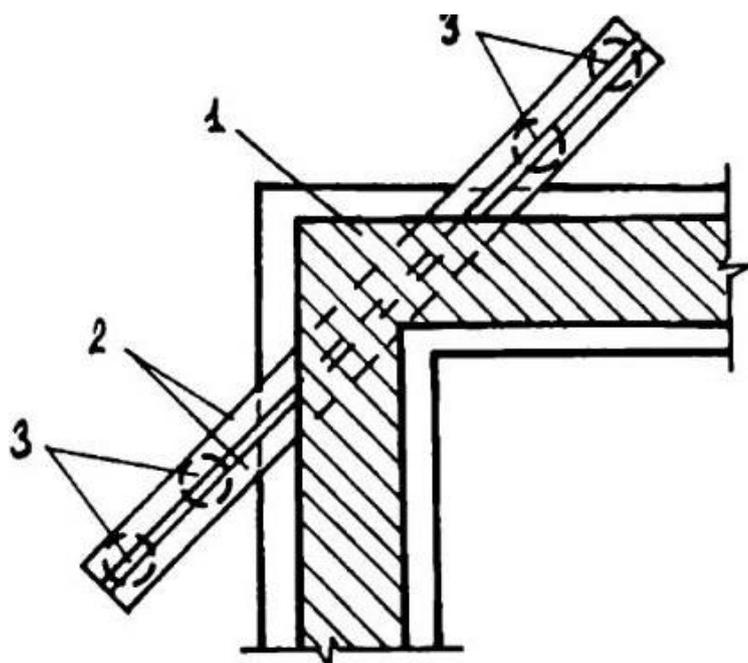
Схема усиления угла ленточного фундамента буронабивными сваями:
